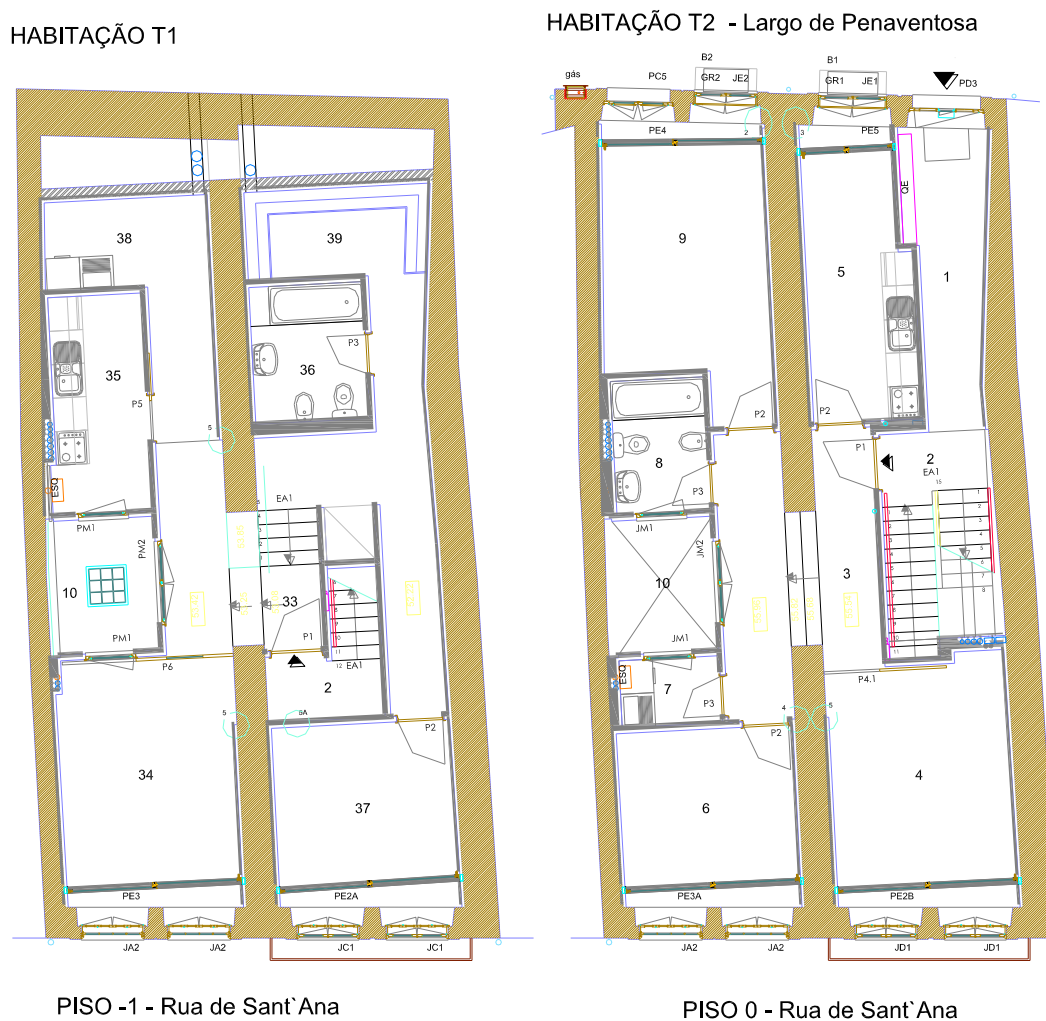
Plantas dos pisos -1 e 0 – Fonte: Projeto de arquitetura
